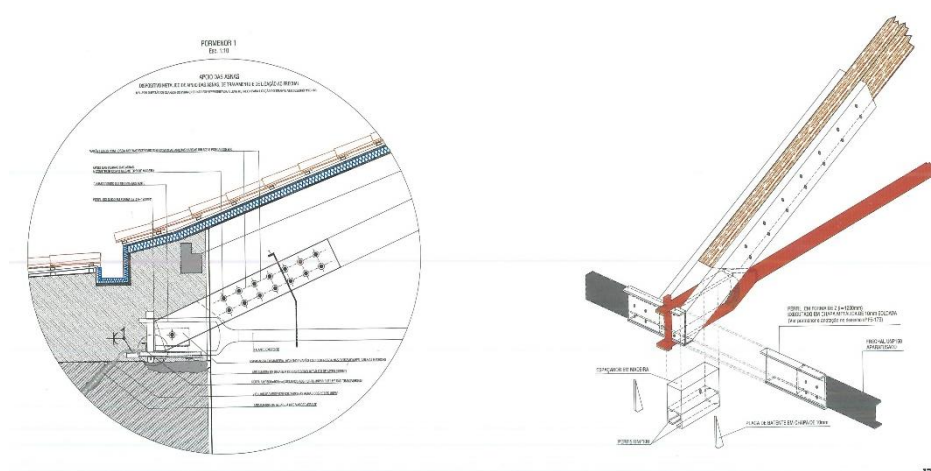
Pormenor Construtivo do Sistema de Apoios e Ligação
